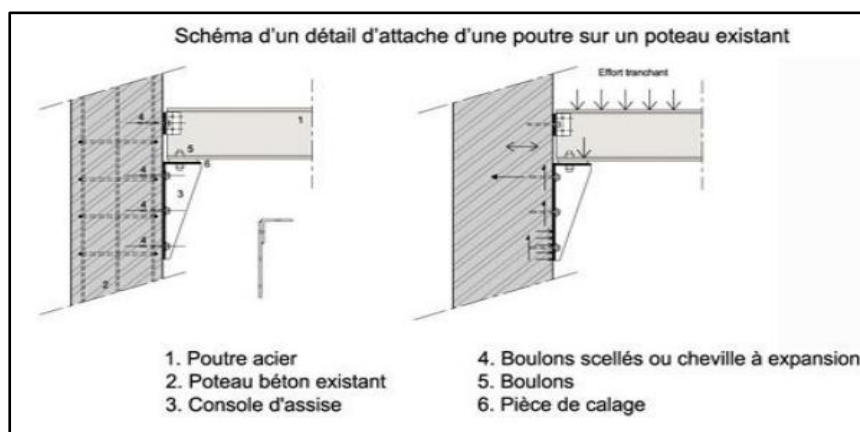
Schéma d'un détail d'attache d'une poutre sur un poteau existant.
